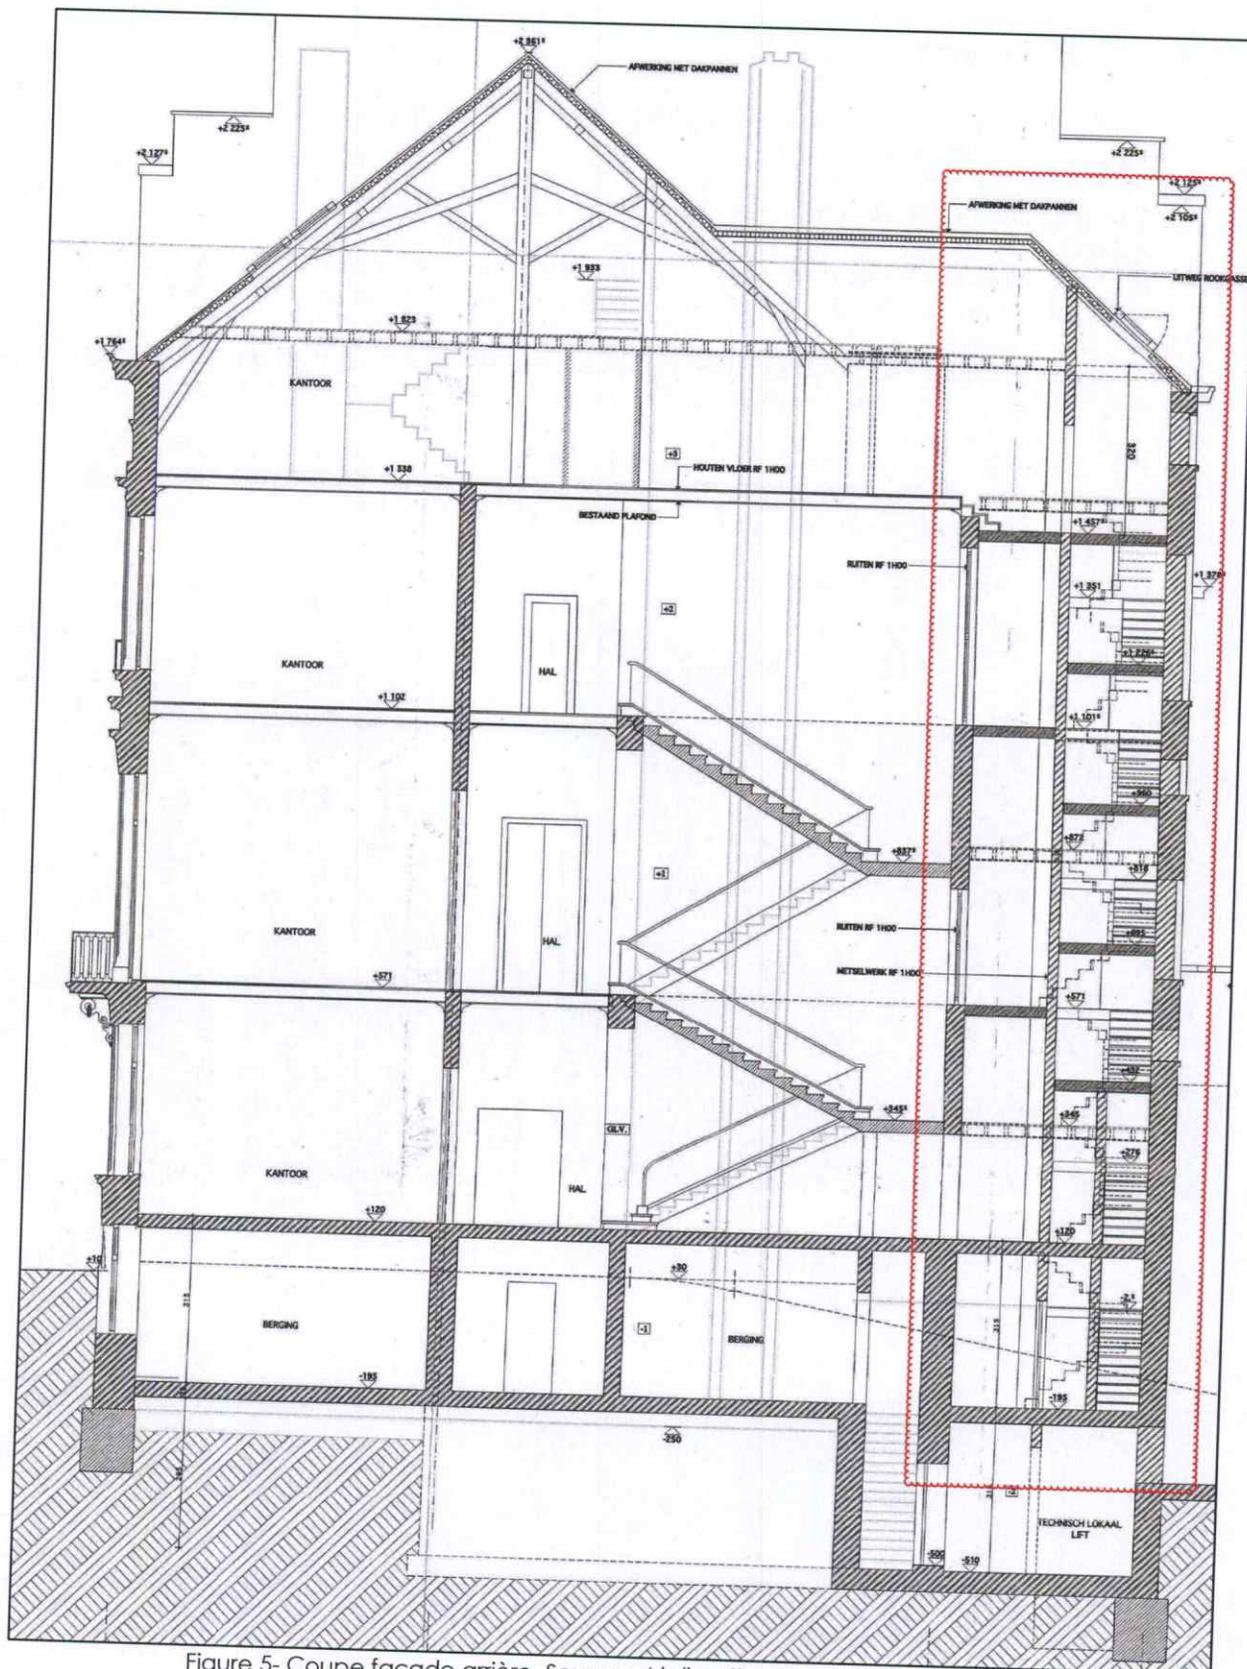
Coupe façade arrière. Source : Atelier d'art Urbain – 1999 - Extrait du dossier d'exécution pour la modification de la façade arrière
